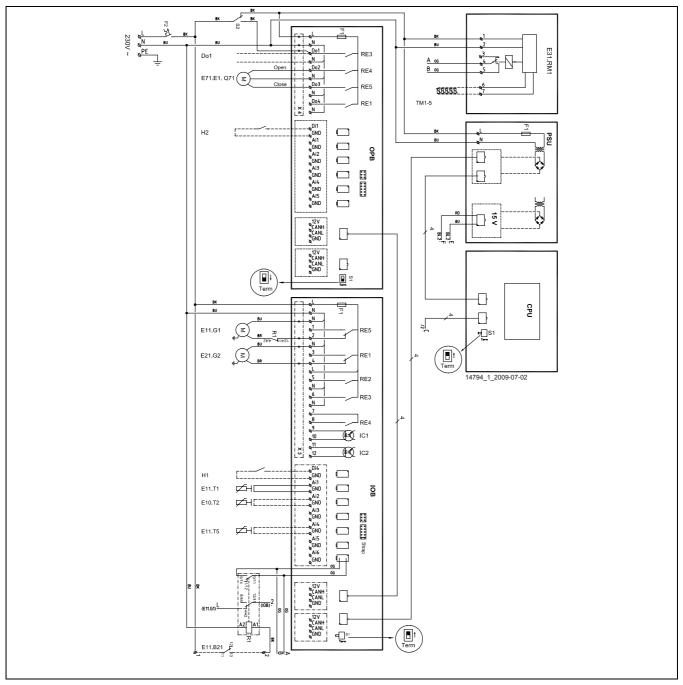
Schema di cablaggio del modulo idraulico interno AW
